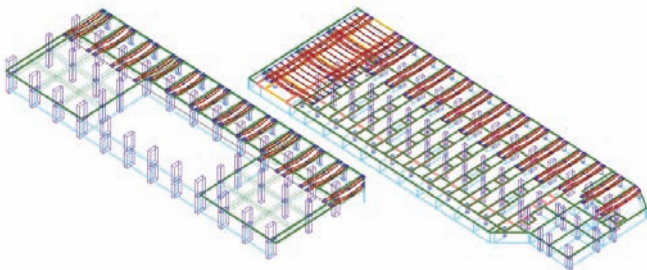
Plan dispunere toroane planșeu peste subsol Peluza Nord / Sud
